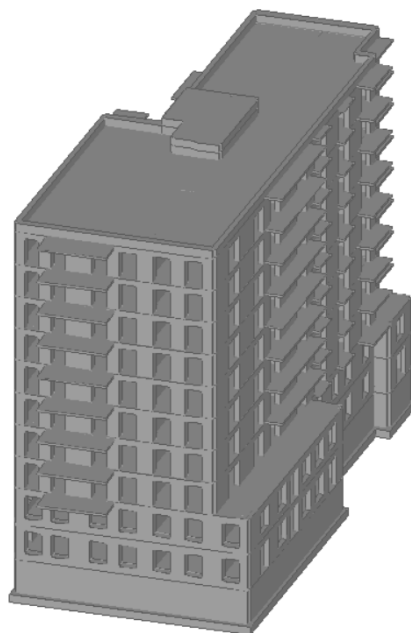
Розрахункова схема будівлі в 3D режимі
